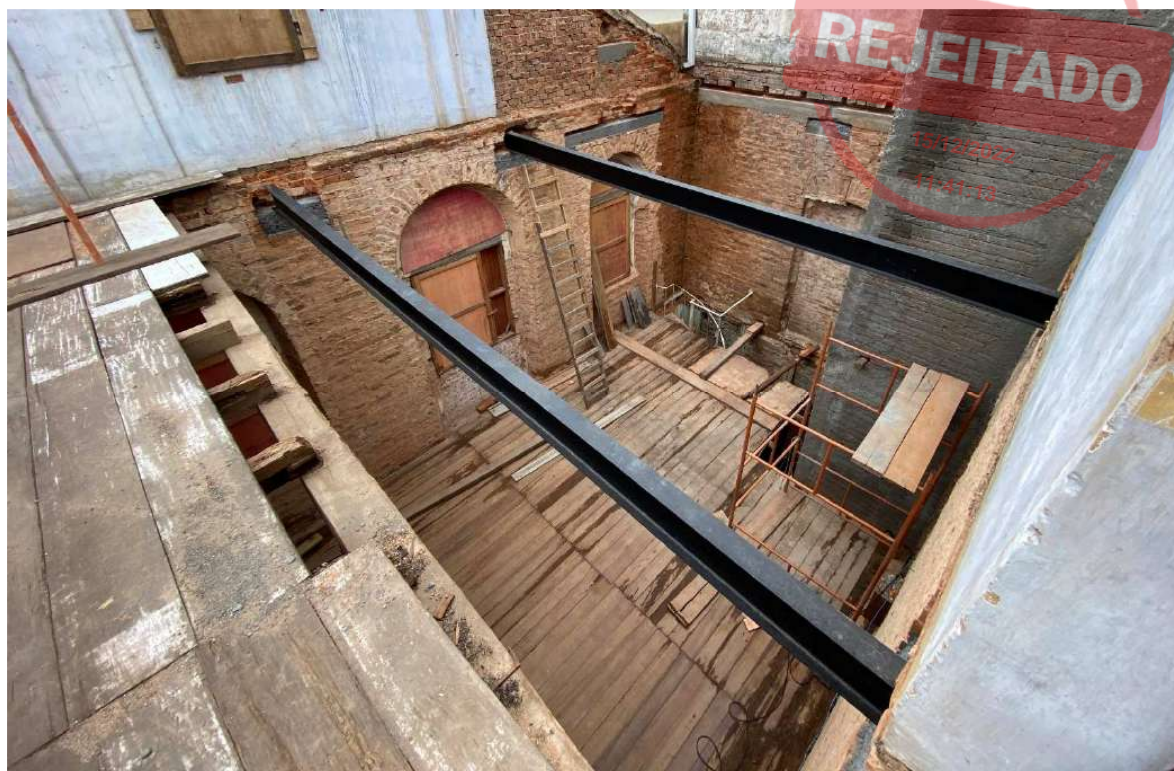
Vigas metálicas apoio do barroteamento do entrepiso sobre os coxins.
